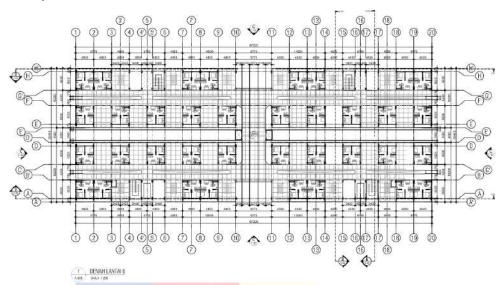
Denah Lantai 4 Rusunawa Cipinang Muara
